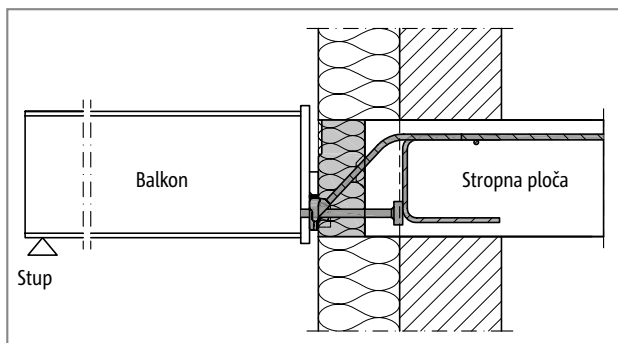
Schöck Isokorb® T tip SQP: priključak na armiranobetonski strop; monolitna konstrukcija zida
